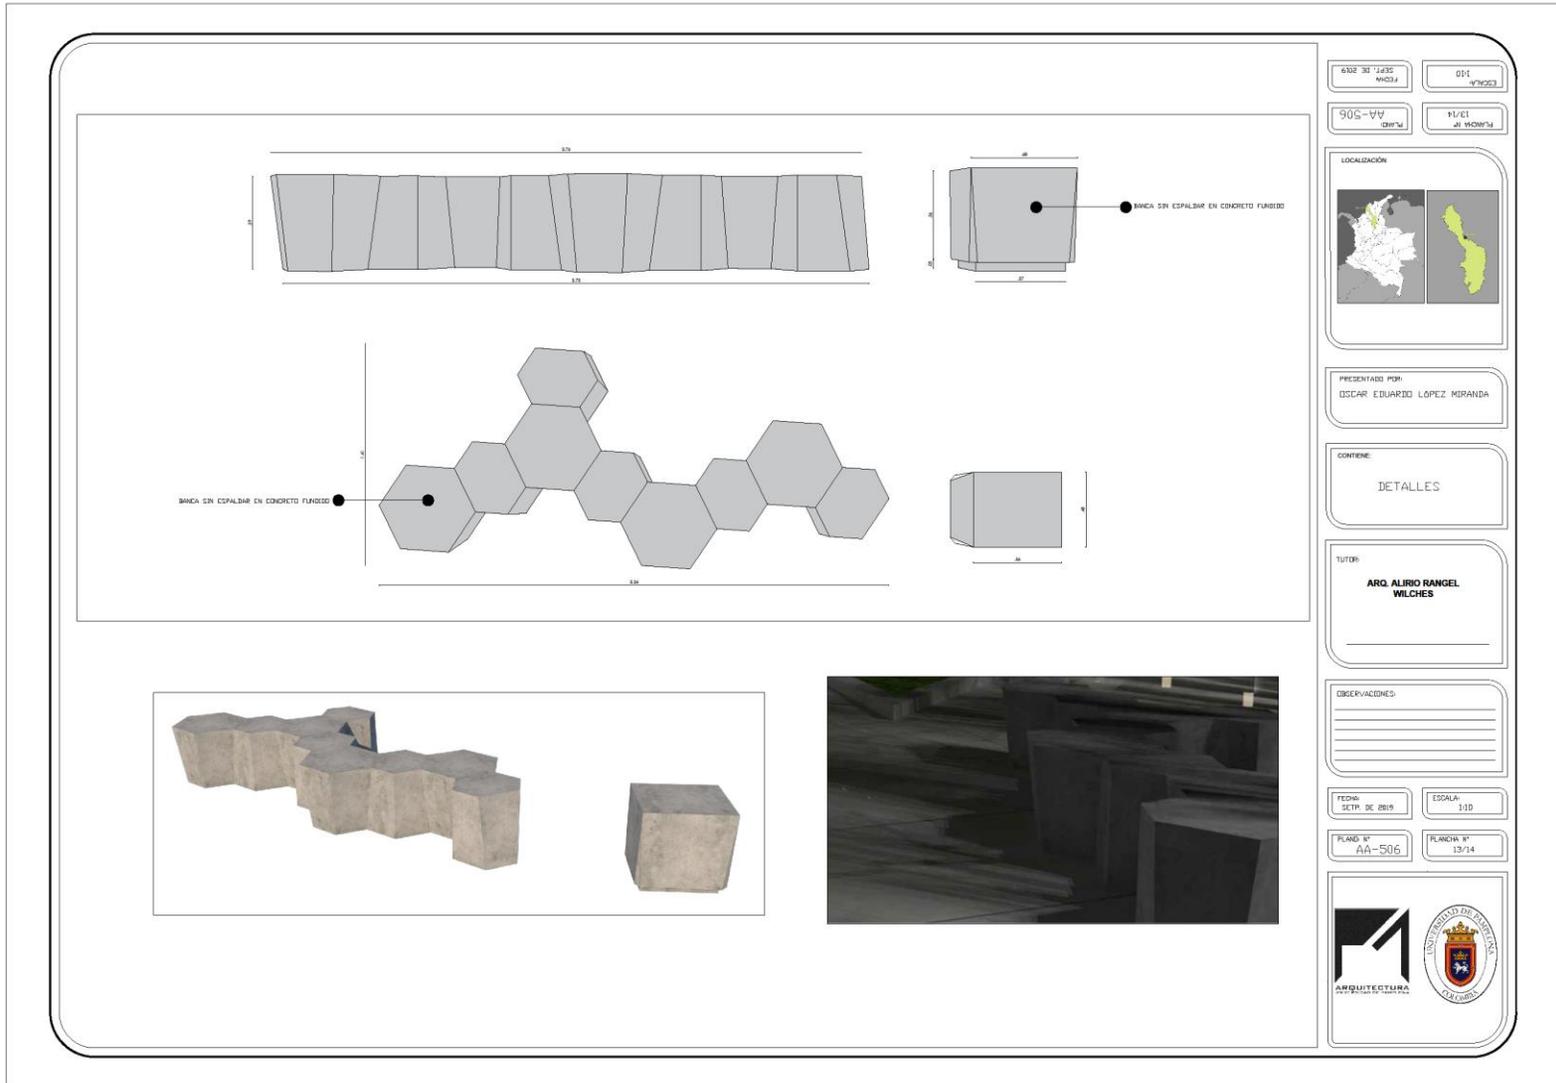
Detalles Bancas prefabricadas. Autor 2019
